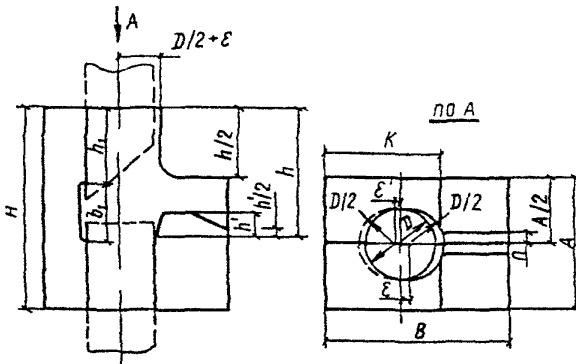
Конструкция инвентарной формы для ванной одноэлектродной сварки соединений вертикальных стержней
